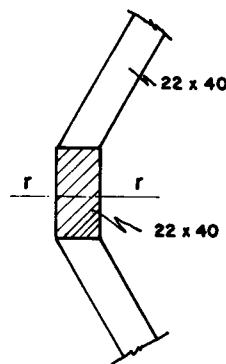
b - LIGAÇÃO VIGA - PILAR
